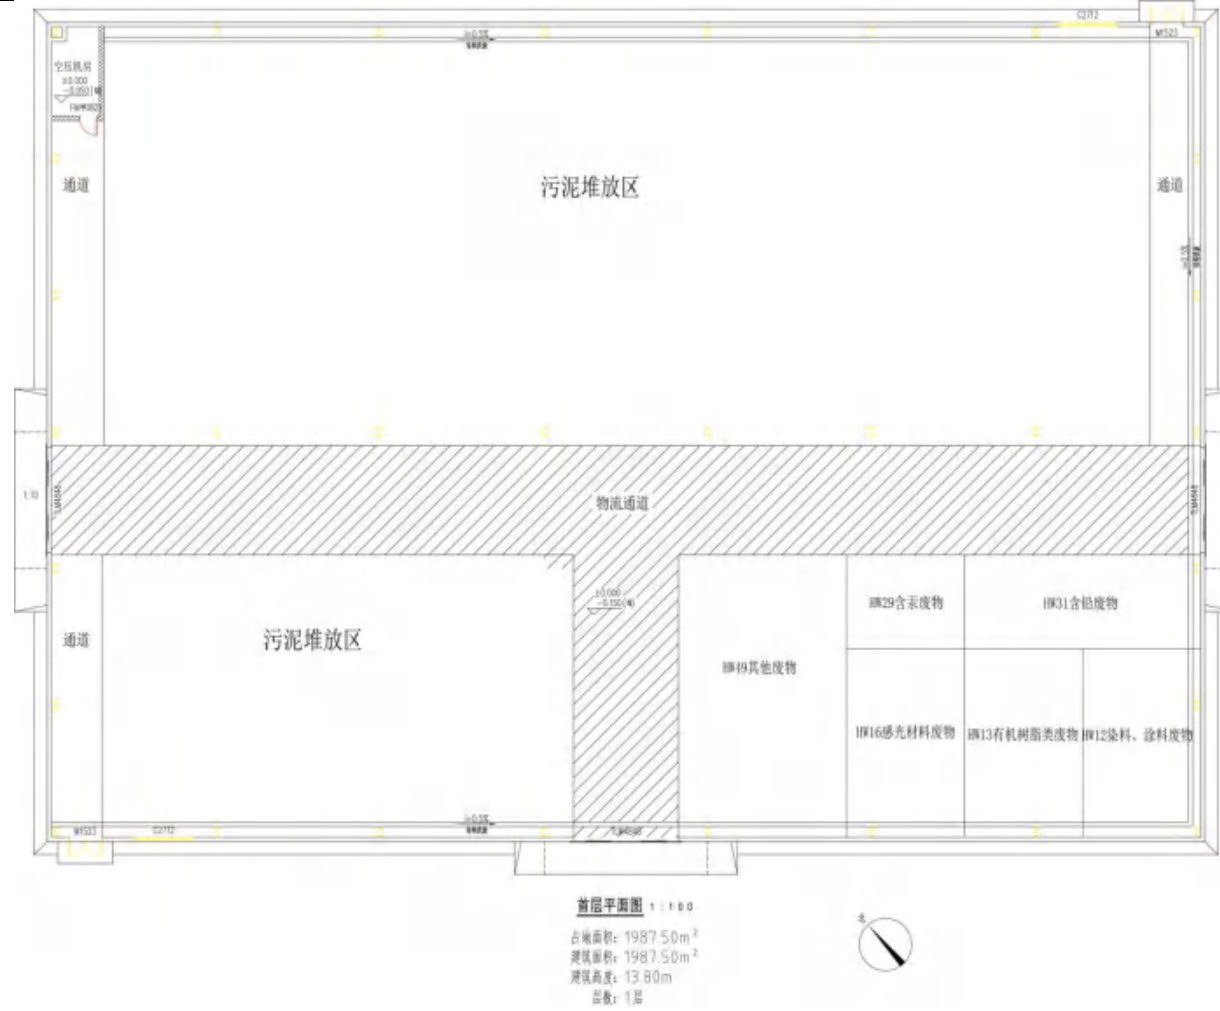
原技改扩建项目综合仓库暂存物料平面布置图
